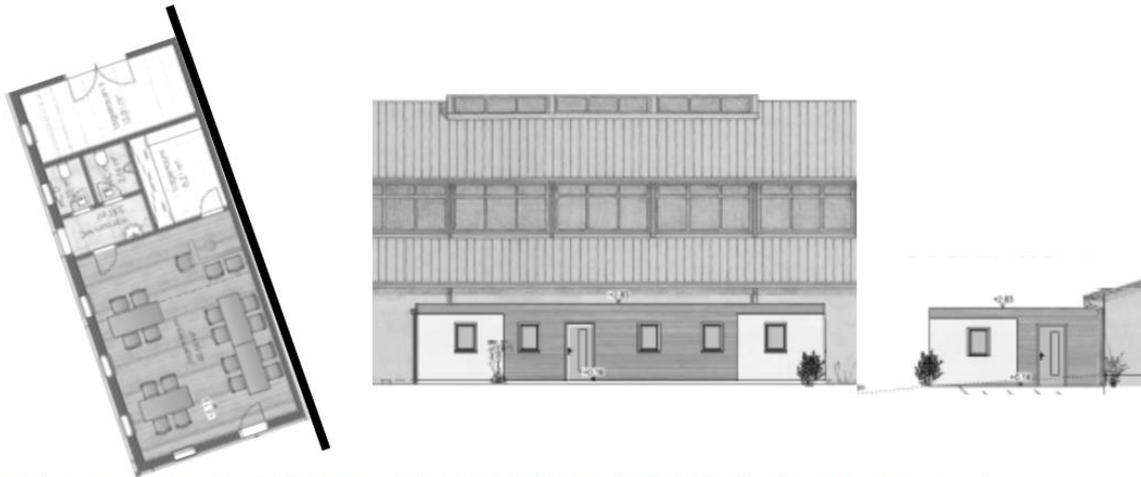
Grundriss, Ansicht West und Ansicht Süd ohne Maßstab aktueller Planungsstand
